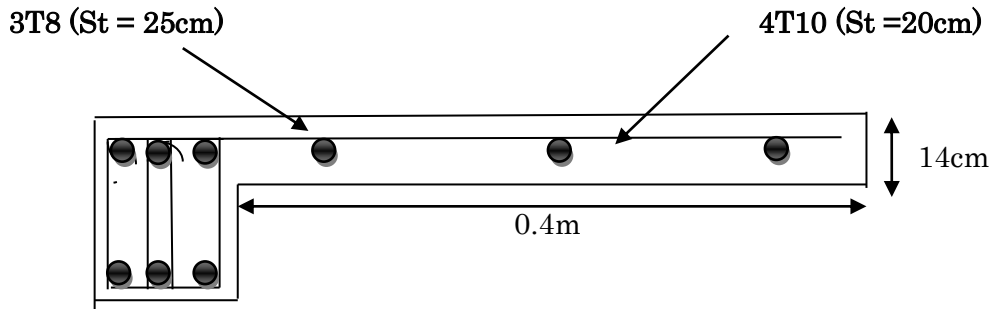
Schéma de ferrailage de la dalle sur 1 appui (balcon)
